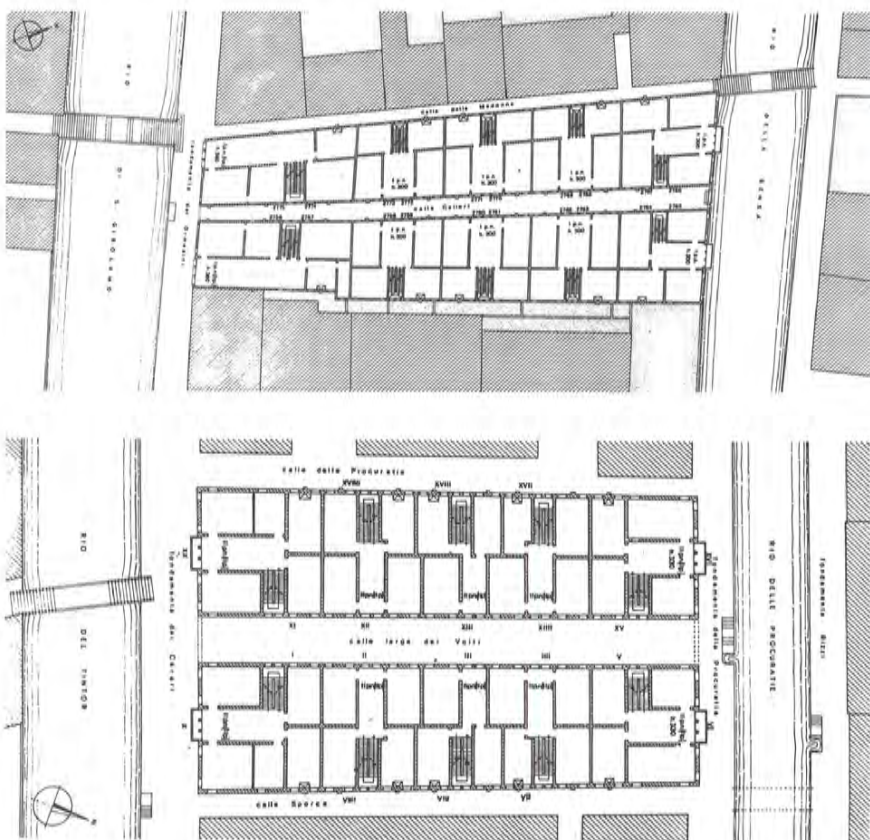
La calle-corte più piccola si rivela improvvisamente all'osservatore con un impianto prospettico che asseconda gli allineamenti dei tessuti preesistenti
